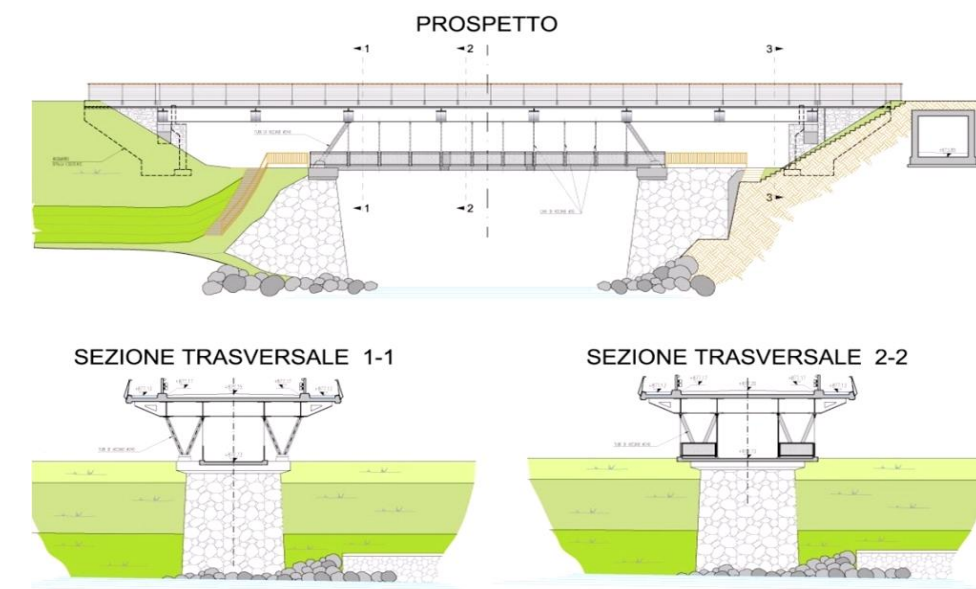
Ponte sul Fiume Noce – Prospetto e sezioni
